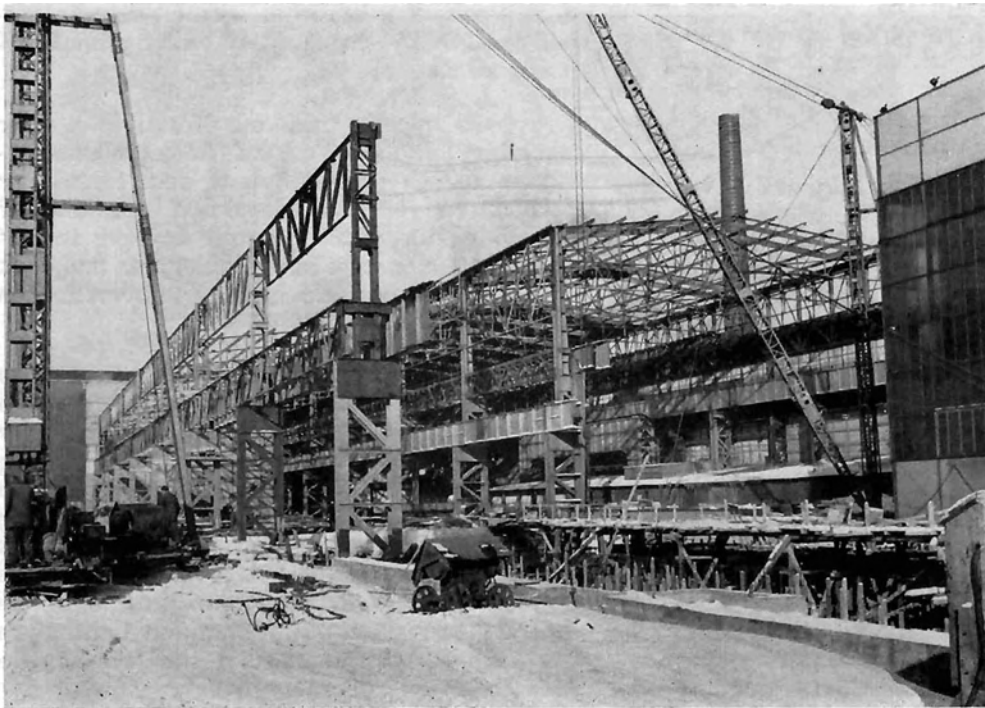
Anbau einer schweren Walzwerkshalle an ein bestehendes Blechwalzwerk in Linz
